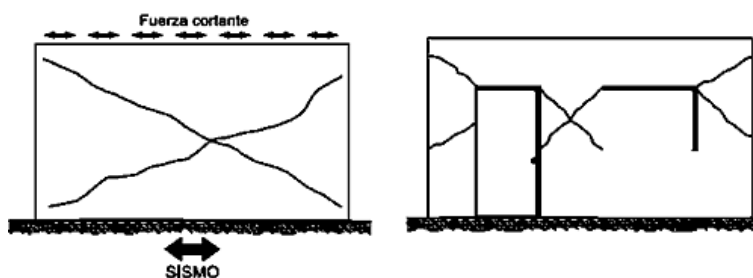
Grietas diagonales debidas a fuerzas en el plano del muro
